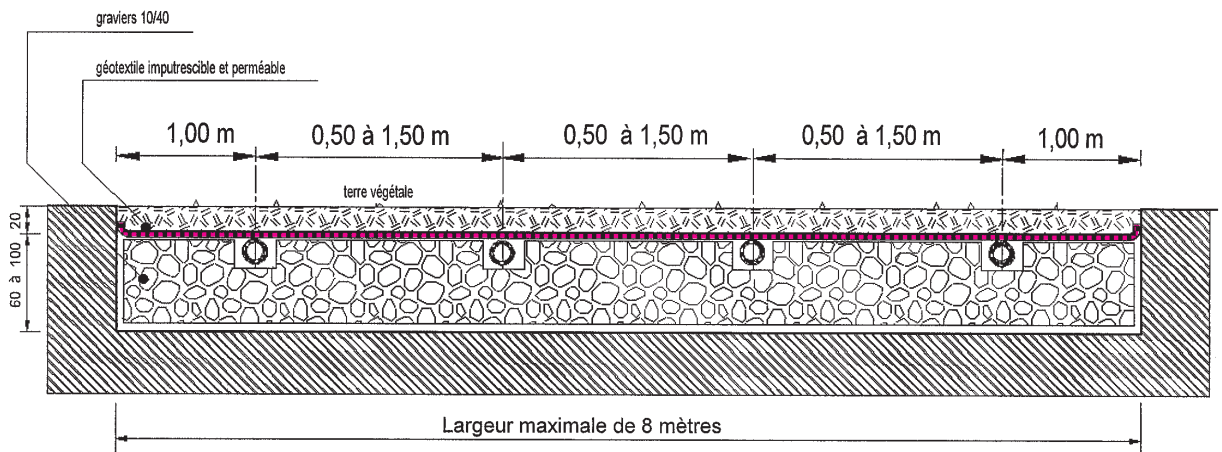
coupe transversale sur lit d'épandage à faible épaisseur
